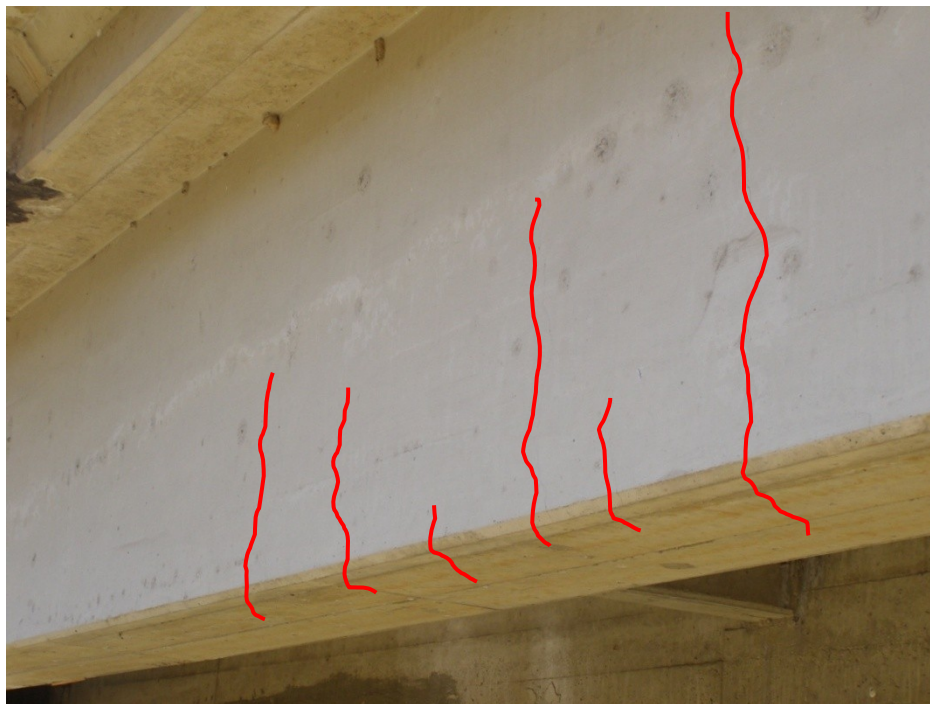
Grietas por flexión en el centro de las vigas principales (típico).
